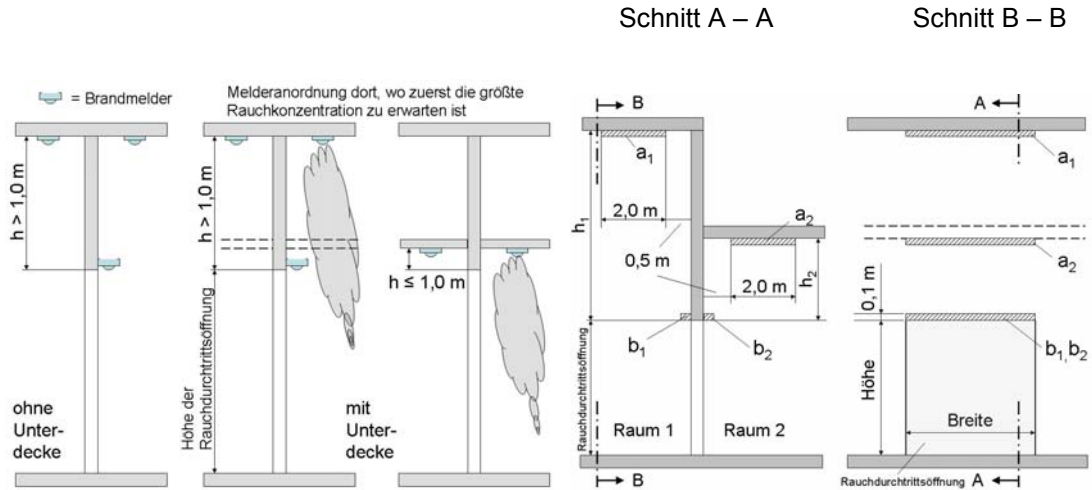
Maßgebende Höhe der Deckenunterfläche Bild 2: Installationsbereiche
